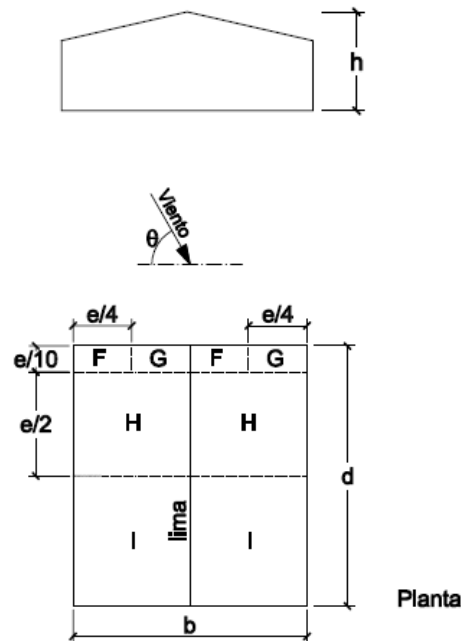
Zonas de la cubierta de tenis para viento longitudinal.
